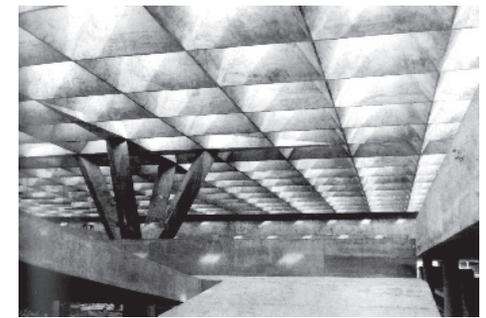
Vista do hall acesso com a rampa e iluminação teto
